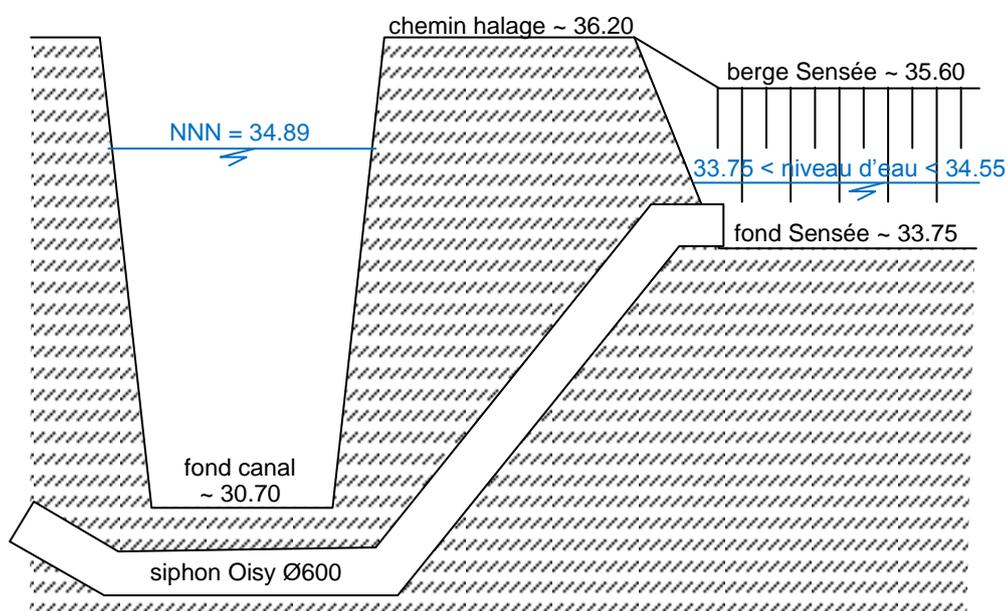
Coupe longitudinale du secteur au niveau du passage en siphon de la Sensée aval
